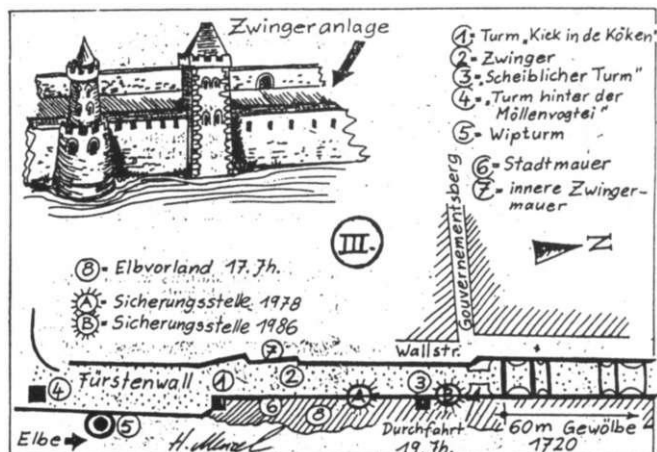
Grundriß des Fürstenwalls und Darstellung der Zwingeranlage des 16./17. Jh.
